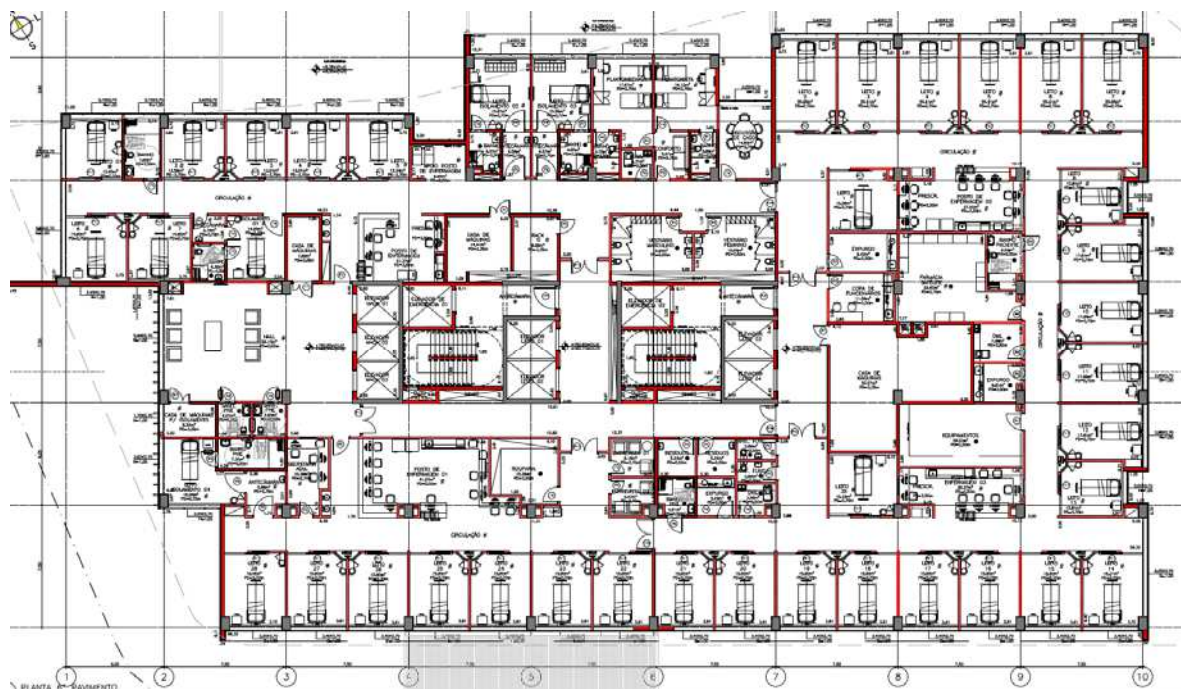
Planta 6º Pavimento. Leitos – UTI adultos.
